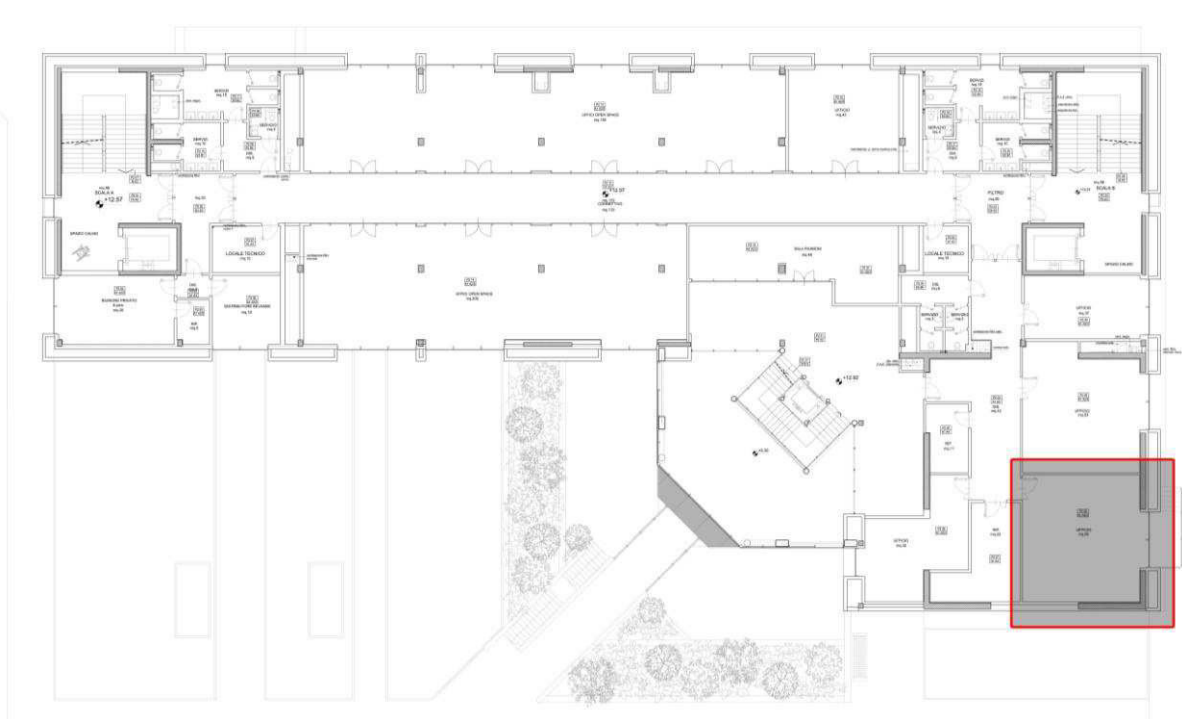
Pianta secondo piano con individuazione dell'ambiente analizzato.
